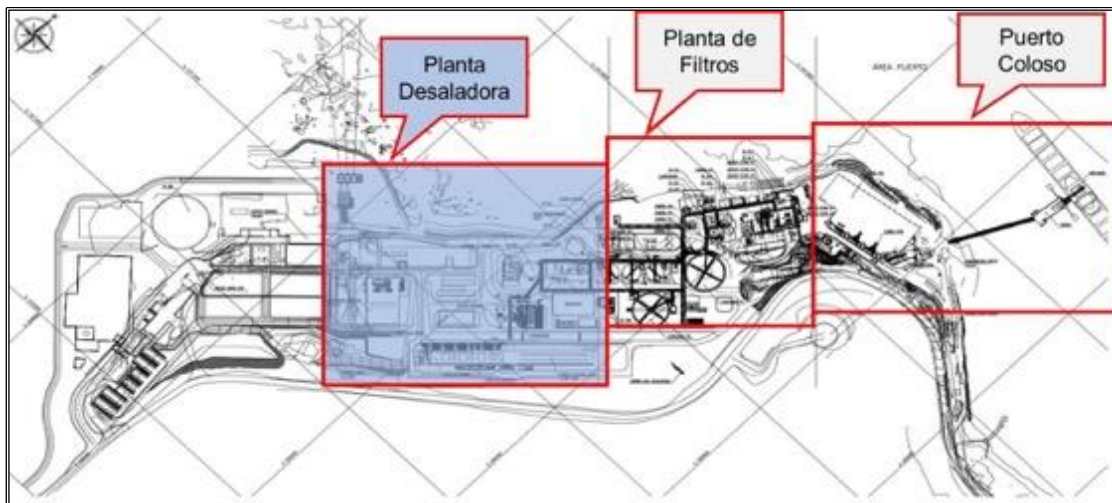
Vista general de las instalaciones de la Planta Coloso. Se muestran las áreas de Puerto y Muelle, Planta de Filtros y Planta Desalinizadora.
